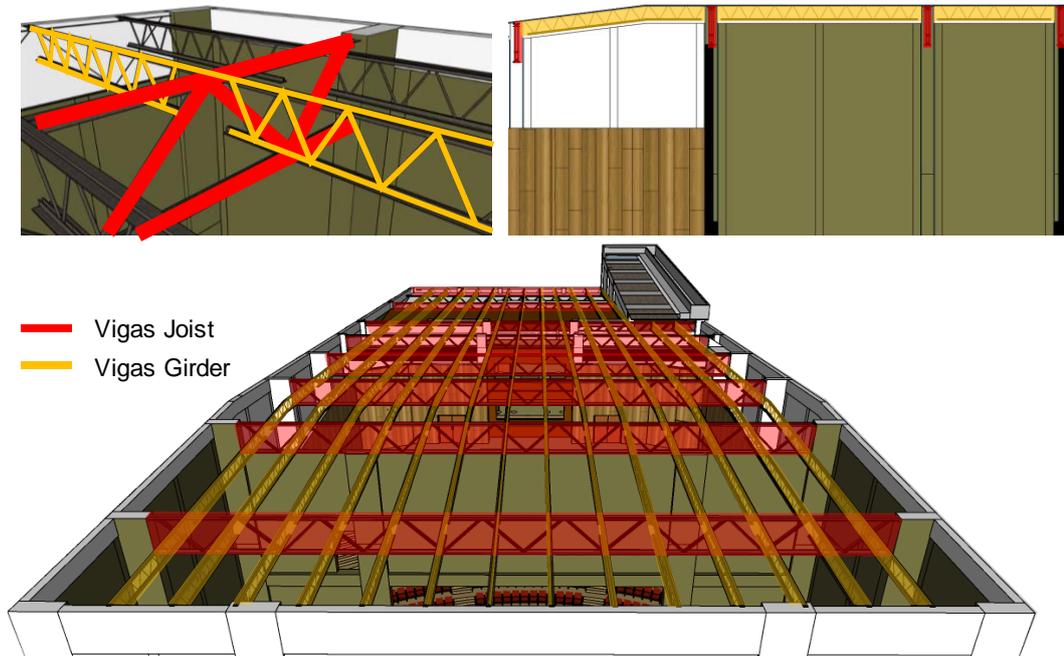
Trama Estructural Vigas Joist y Vigas Girder
